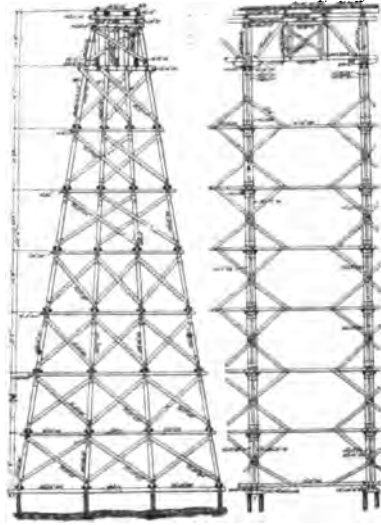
Hauts Trestles du Saint-Paul, Minnéapolis & Manitoba Ry.
